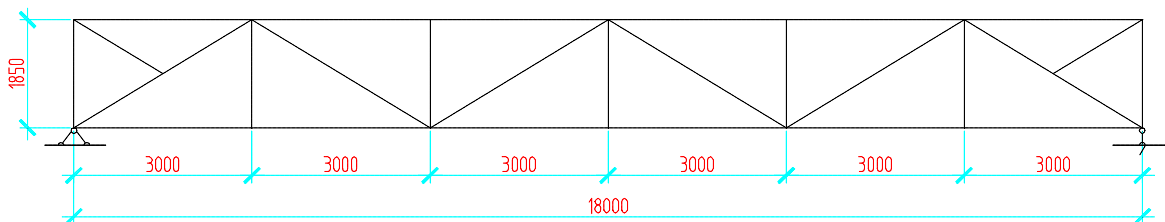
Расчетная схема стропильной фермы _ вариант 2
